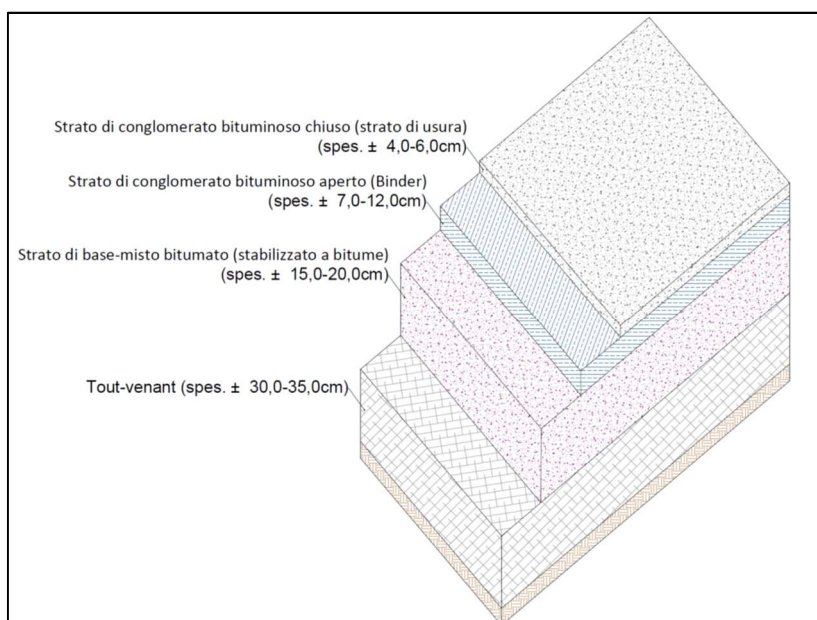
/III: Stratificazione tipo della costruzione della pavimentazione
